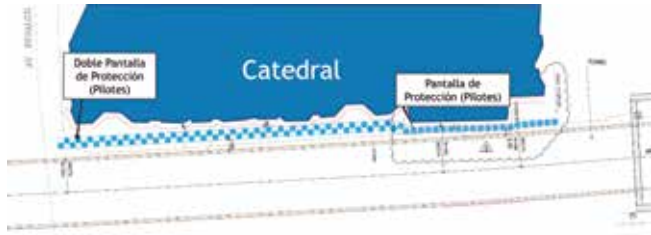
Planta de la primera alternativa propuesta en obra para la protección de la Catedral
